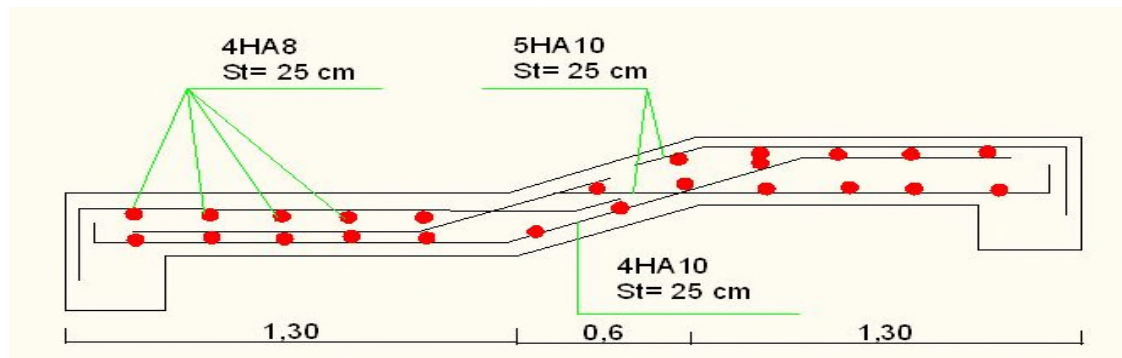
Schéma de ferrailage de l'escalier type 2 volée 2
